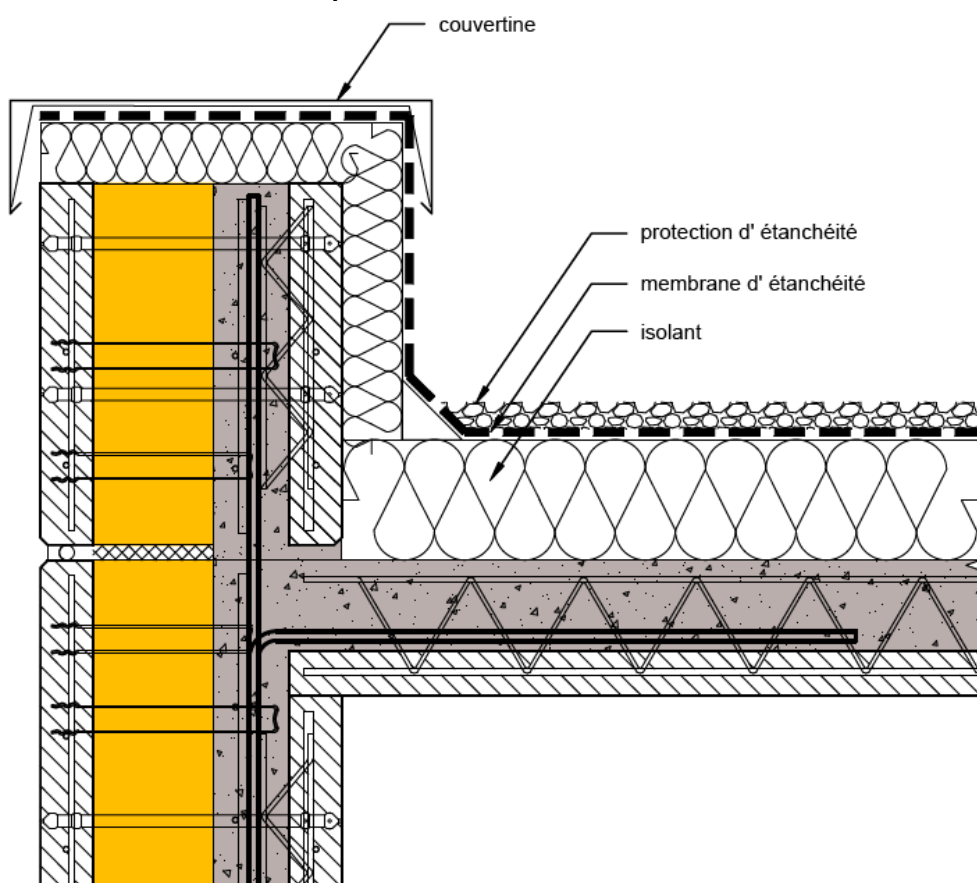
Liaison murs 2000+ COMFORT avec prédalle. Cas toiture - terrasse
